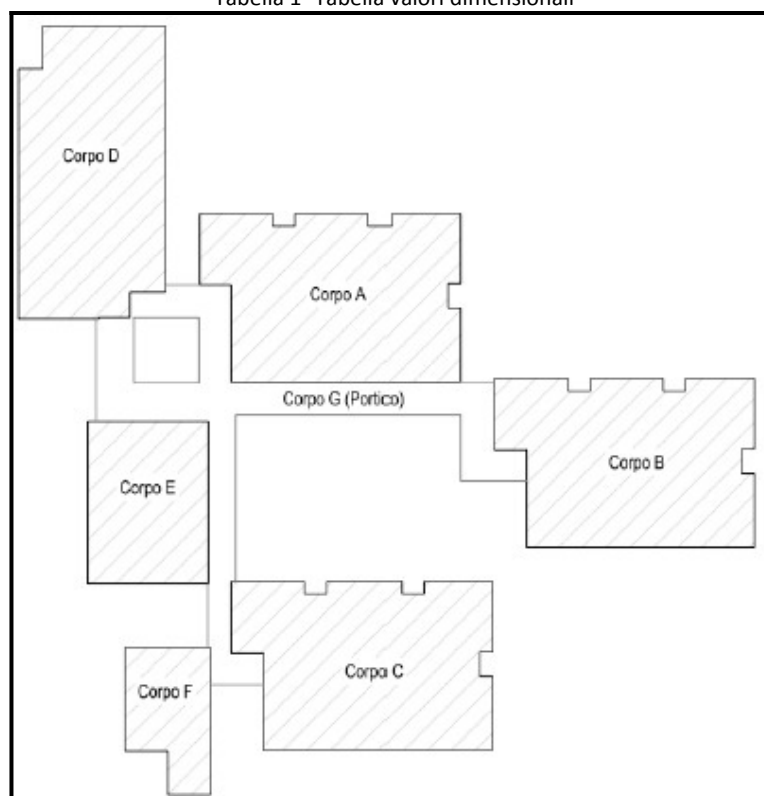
schema planimetrico con identificazione dei corpi strutturali
